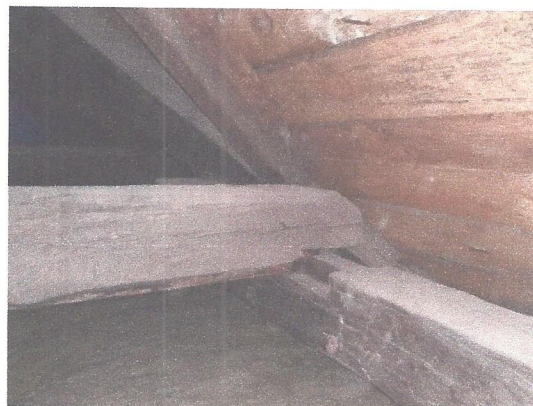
Pokrycie dachu łącznika i sali gimnastycznej
